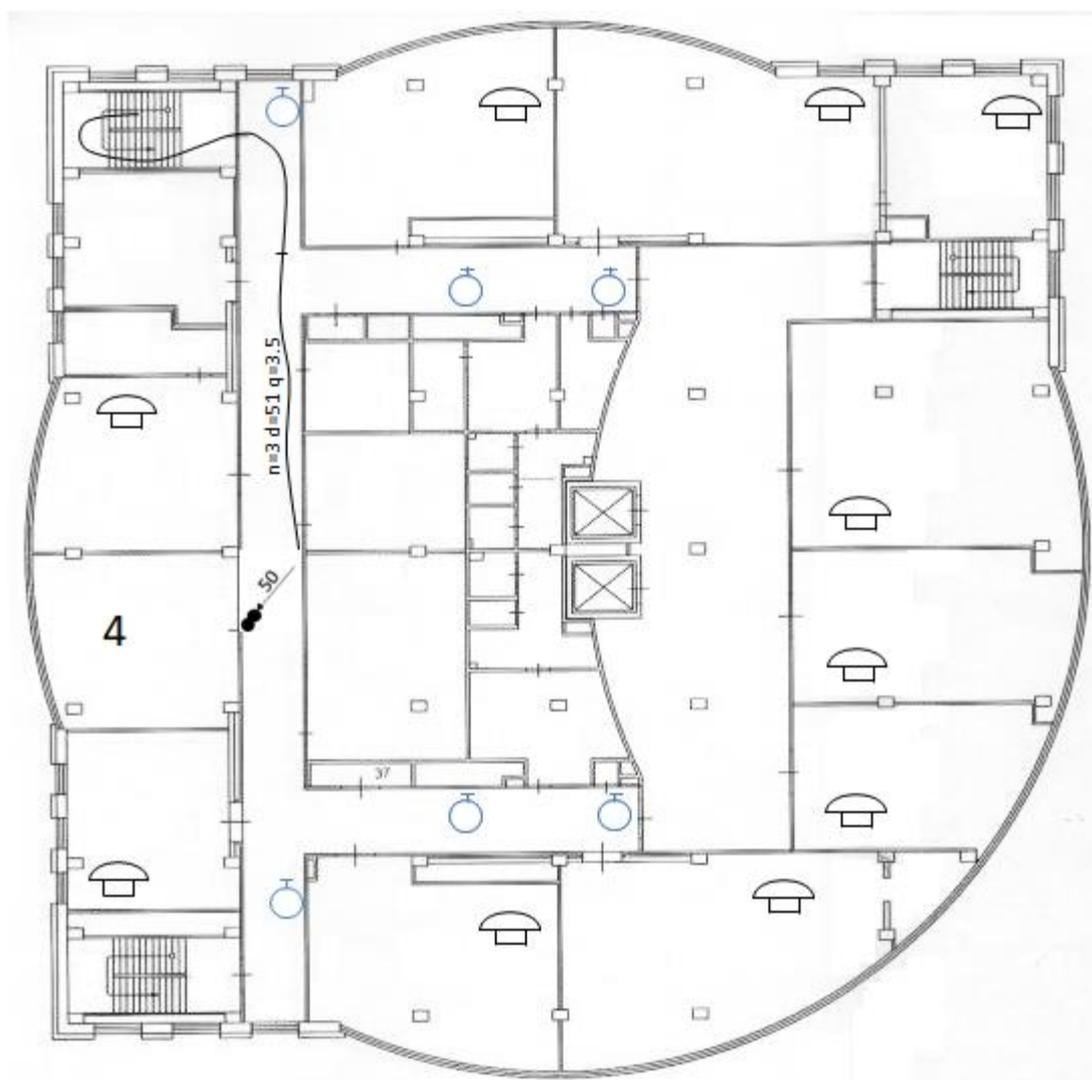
Схема подачи ствола на защиту смежного помещения на 6 этаже
